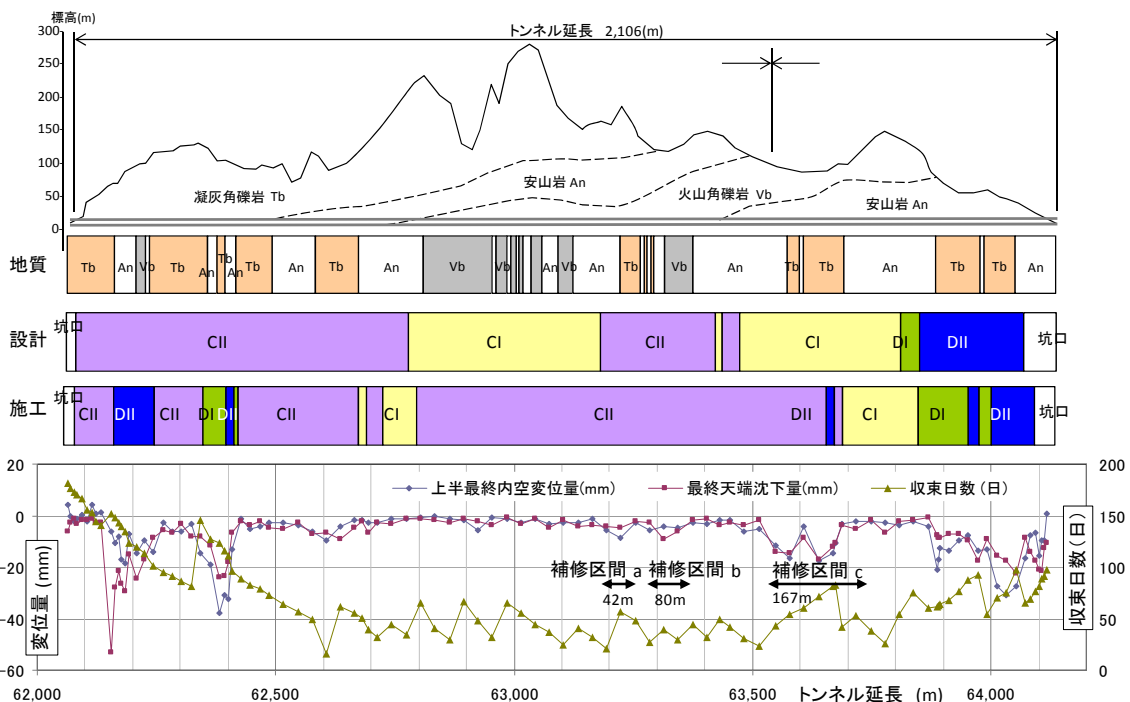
調査トンネルの施工記録(地質断面図、支保パターン(設計と施工)、変位量および収束日数)¹⁹⁾
